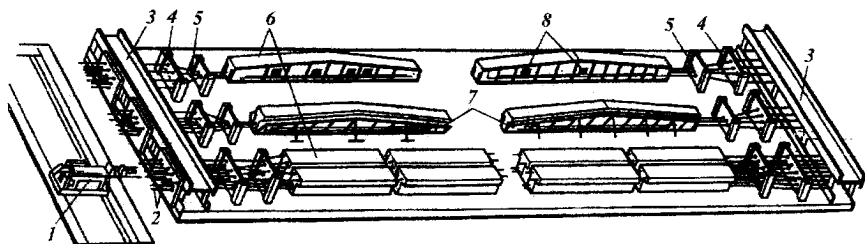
Довгий стенд для виготовлення попередньо напружених конструкцій:
